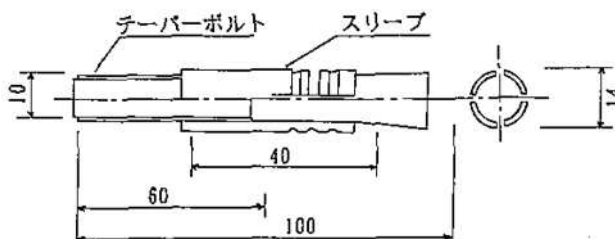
6 現場打境界用アンカー詳細図 単位(mm)
